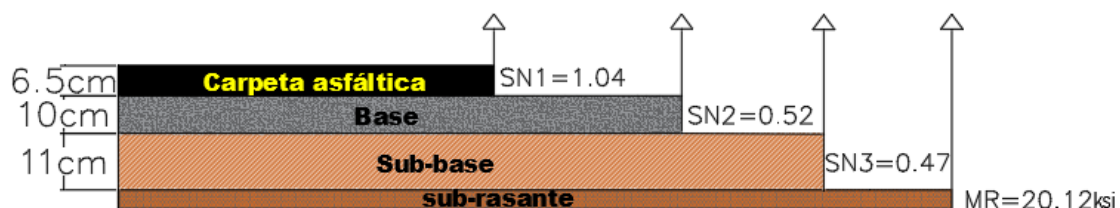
Detalle de paquete estructural de pavimento flexible diseñado
